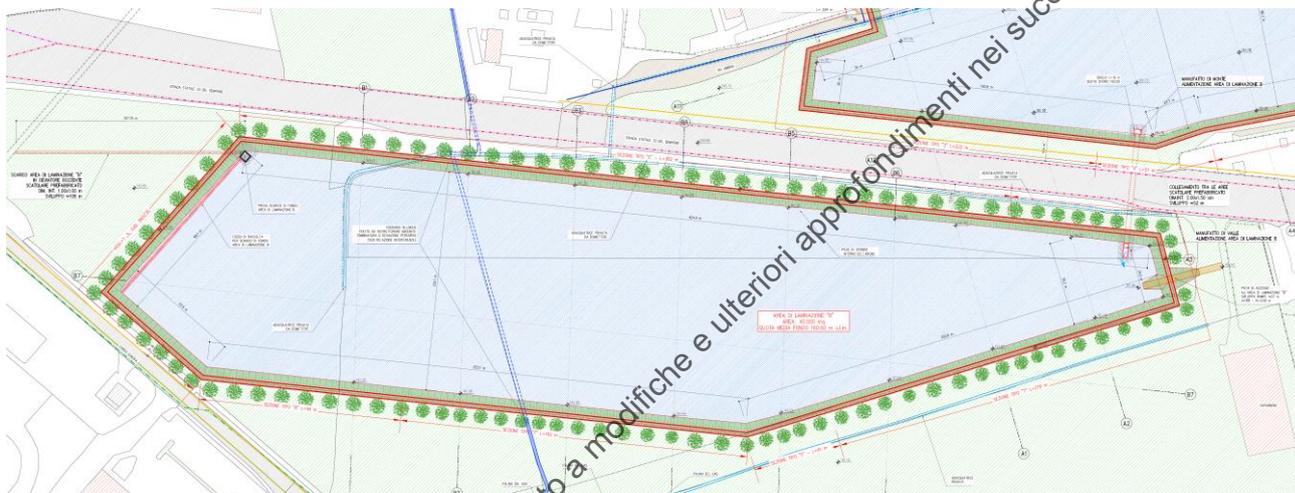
area di laminazione B. Estratto da Tav. 8.2
